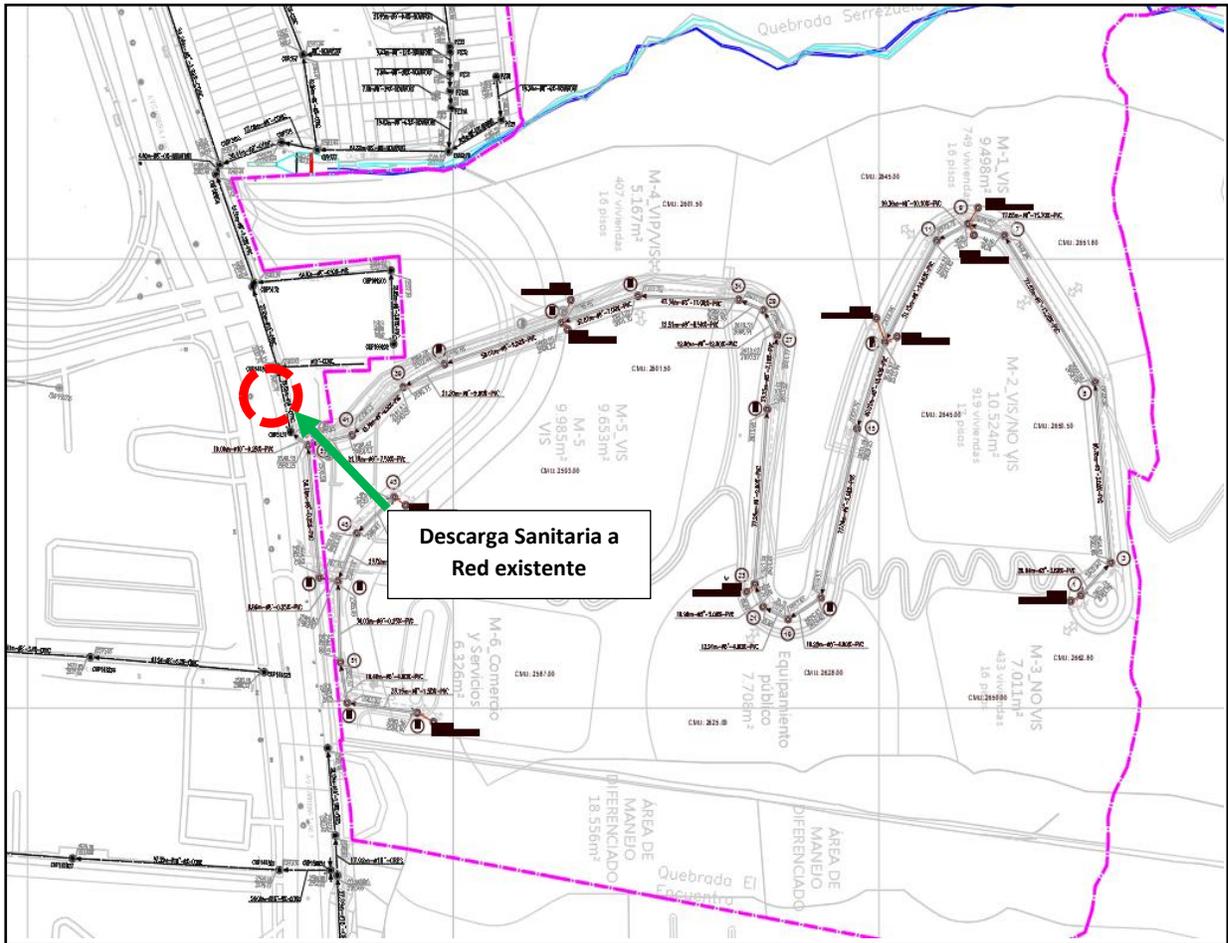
Esquema de Redes Locales Alcantarillado Sanitario.
